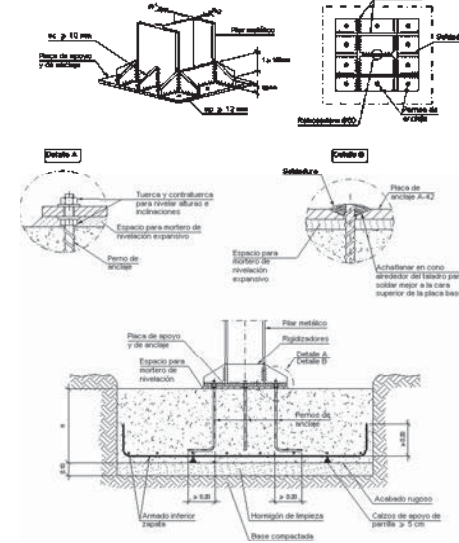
Ejemplo de una zapata aislada de concreto armado de $f'c=250$, en esta ilustración se muestra información más detallada de cómo desplantar un pilar metálico, también se puede apreciar en el plano de cimentación y estructural.¹⁷
